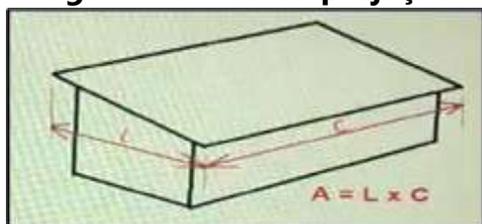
Telhado do Pavilhão 1 do CEHMA.
